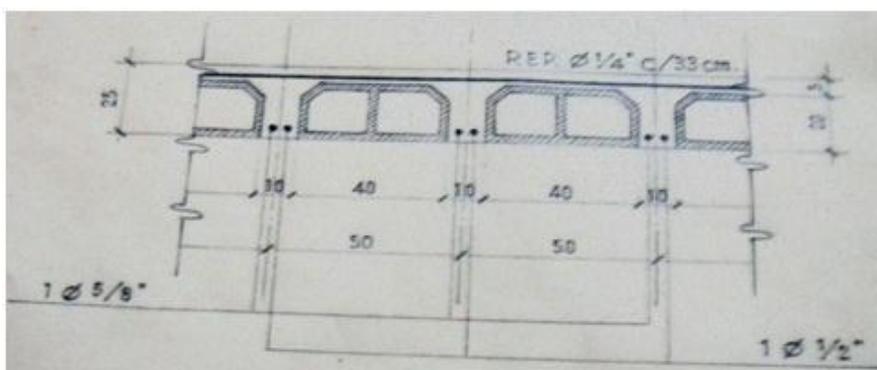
Sección Transversal del Losas del Tercer Piso.
